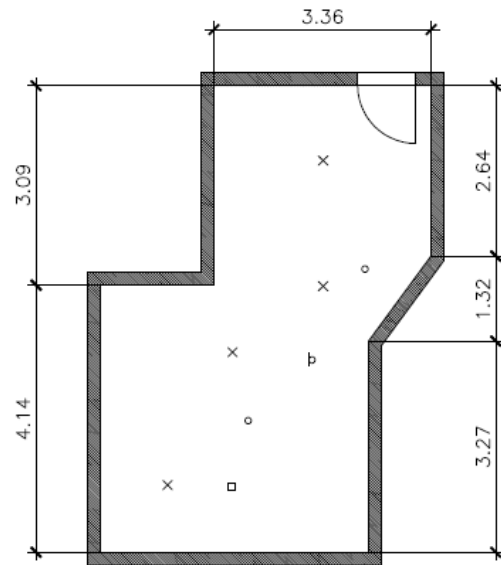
Grundriss (Skizze) Wohnzimmer
